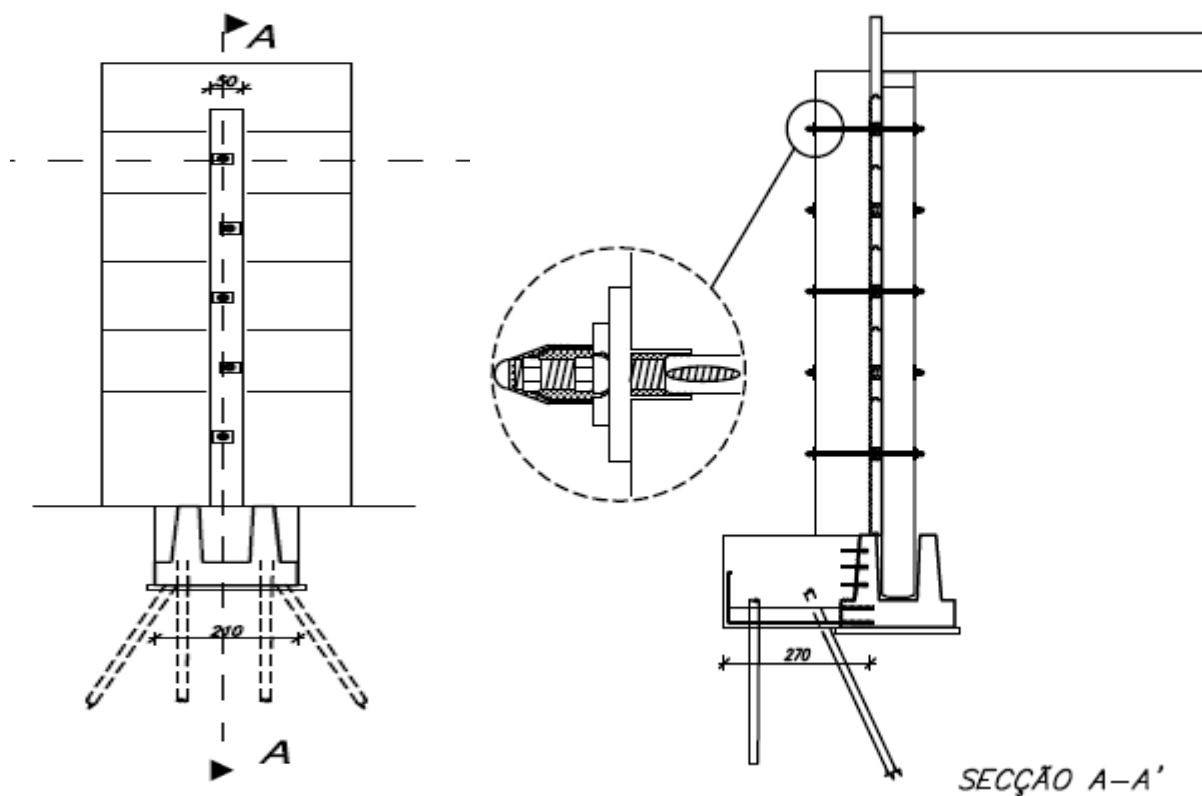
Exemplo de intervenção na ligação dos pilares dos grupos 1, 4 e 5
